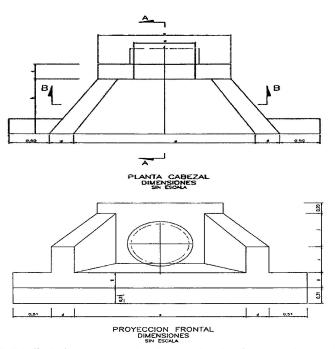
Detalle de dimensiones de la estructura de cabezal en concreto para alcantarilla de  $drenaje^{II}$ .
